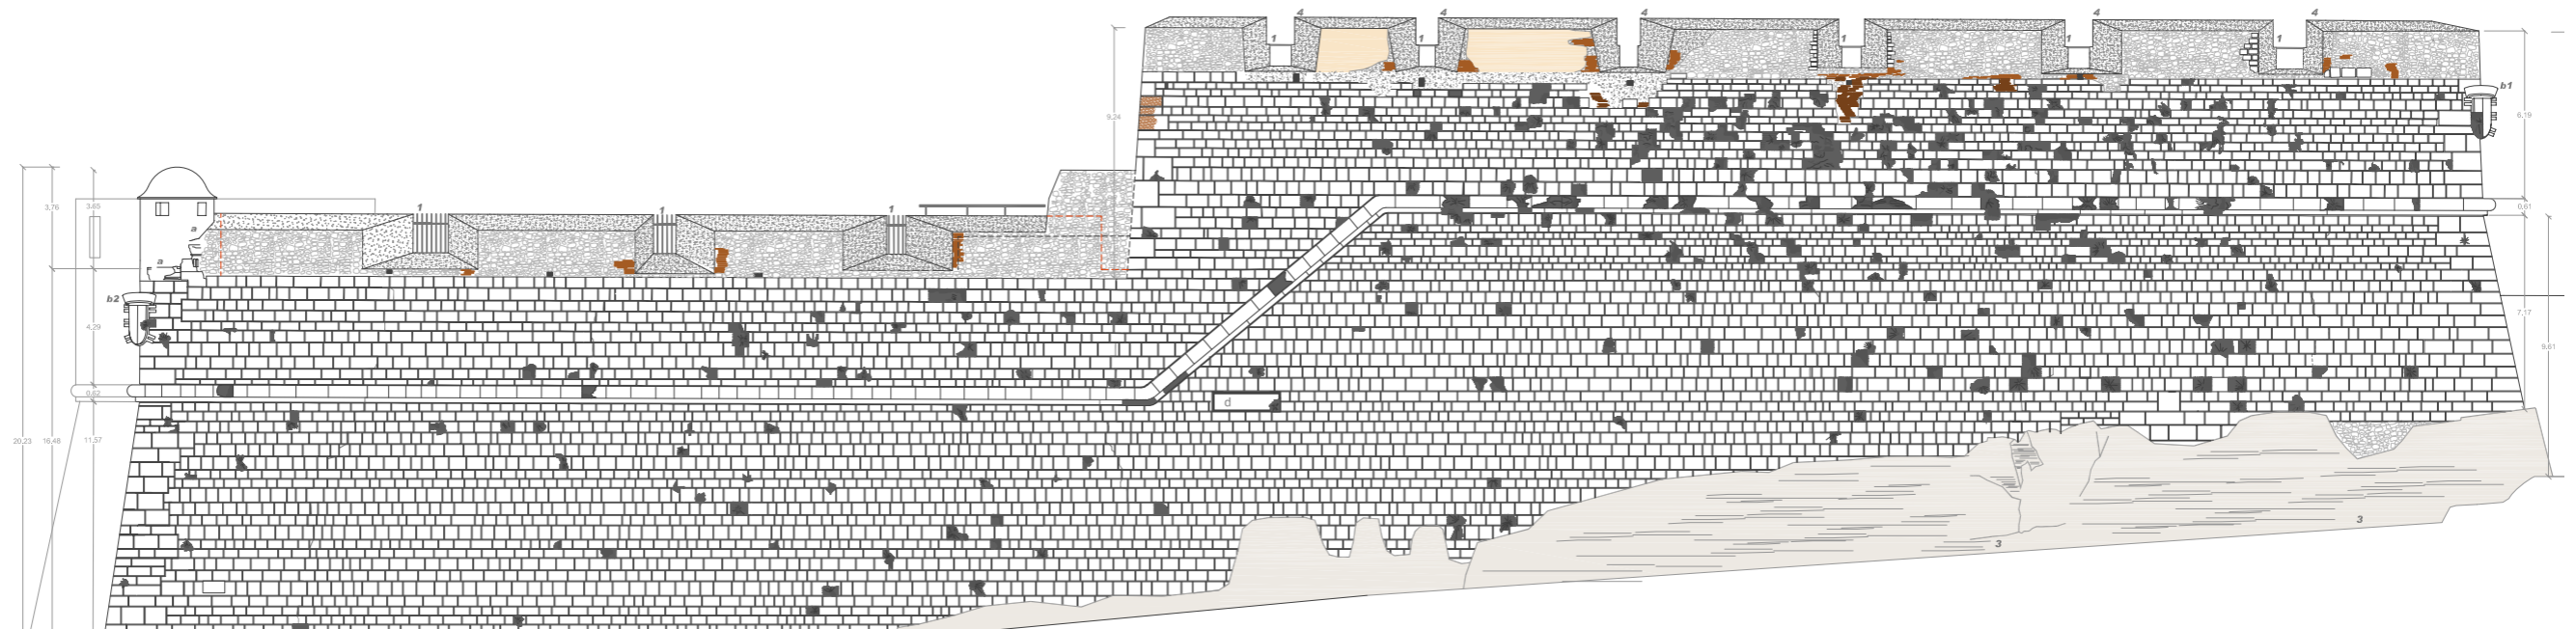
Vista frontal del baluarte Real. Alzado de estado anterior al proyecto intervención. (MJB 2009).
